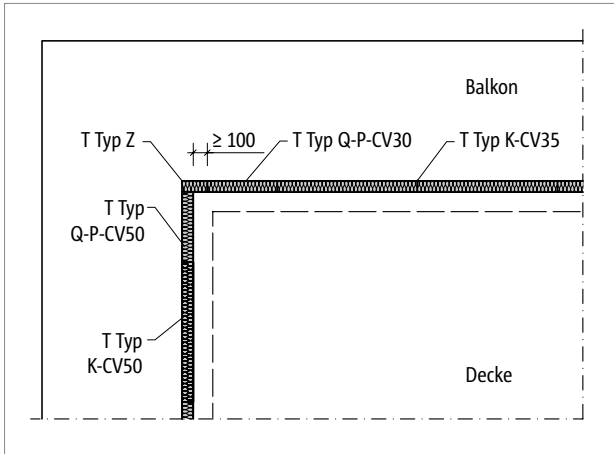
Schöck Isokorb® T Typ Q-P, K: Außenecke; Grundriss bei auskragendem Balkon (Einrücken ≥ 100 mm, gemessen von der Innenseite)
